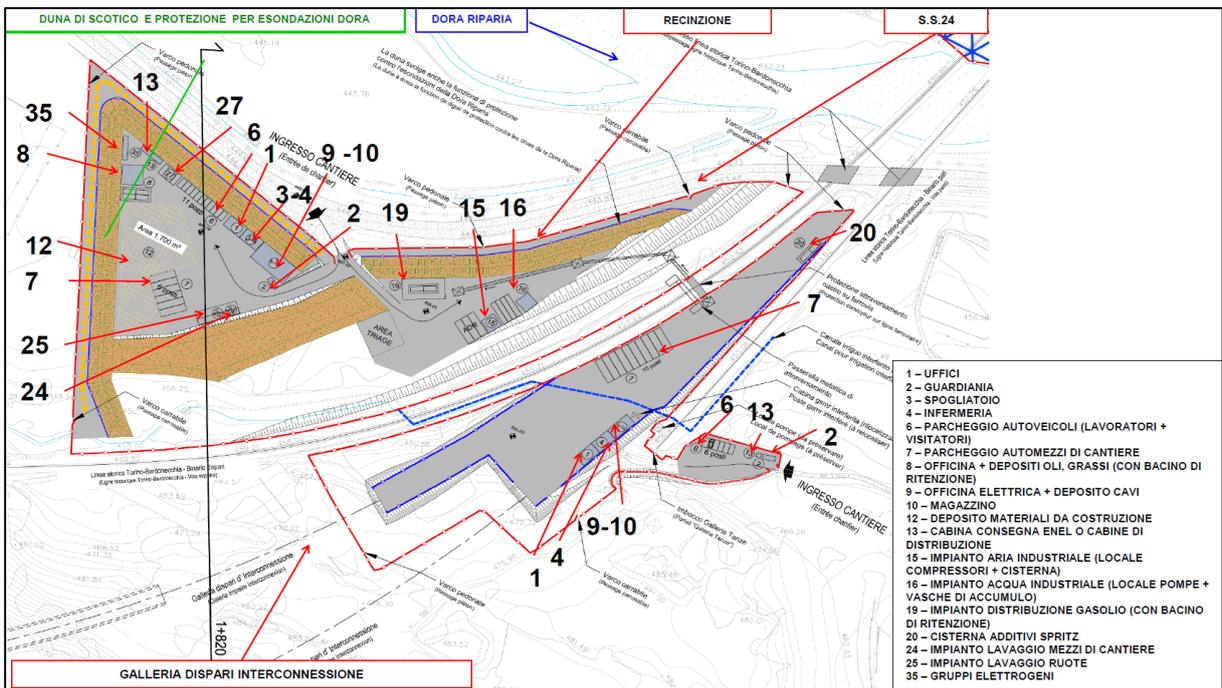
Layout cantiere Imbocco Est Tunnel di Interconnessione
